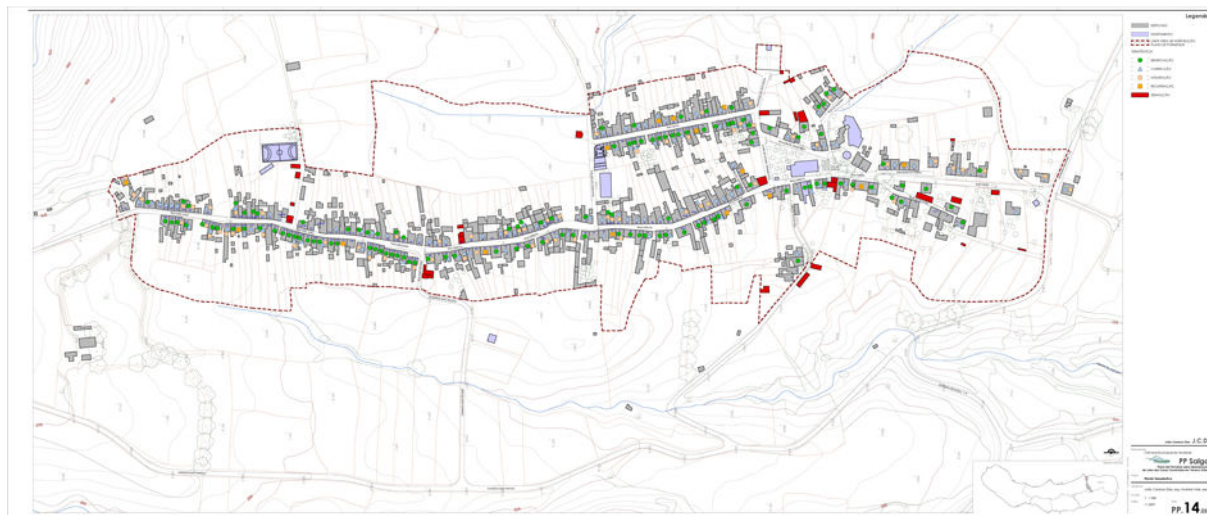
Planta Terapêutica (ver planta PP.14.05)
